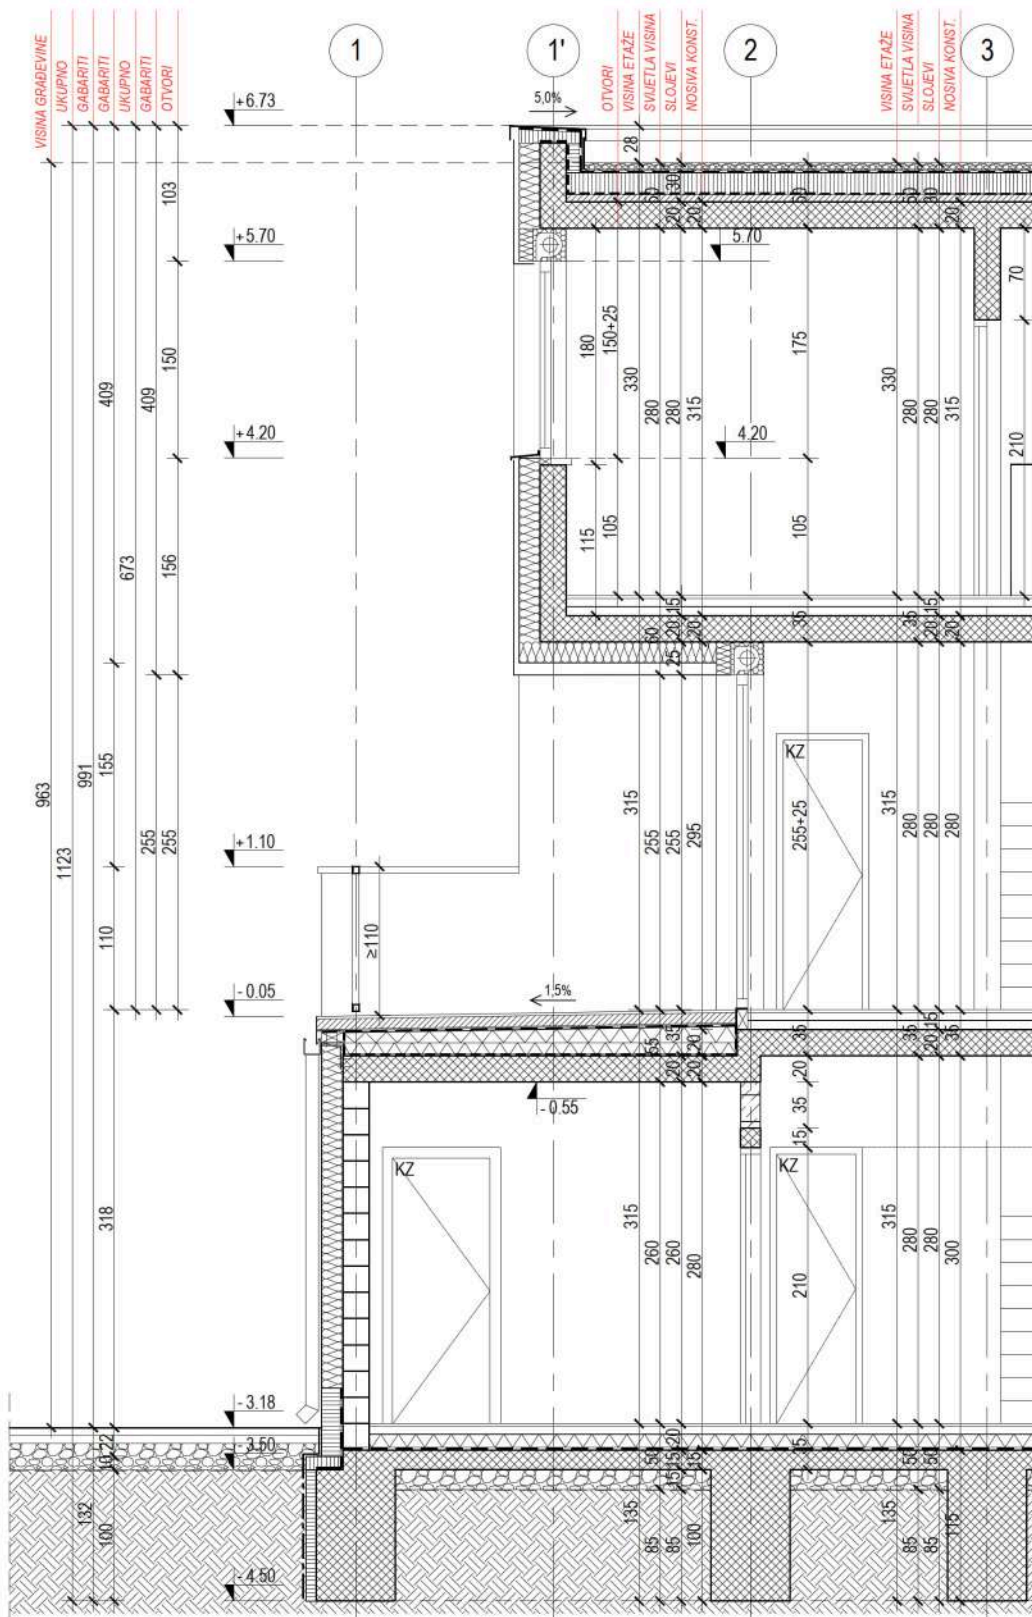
Primjer kotiranja u mjerilu 1:200
